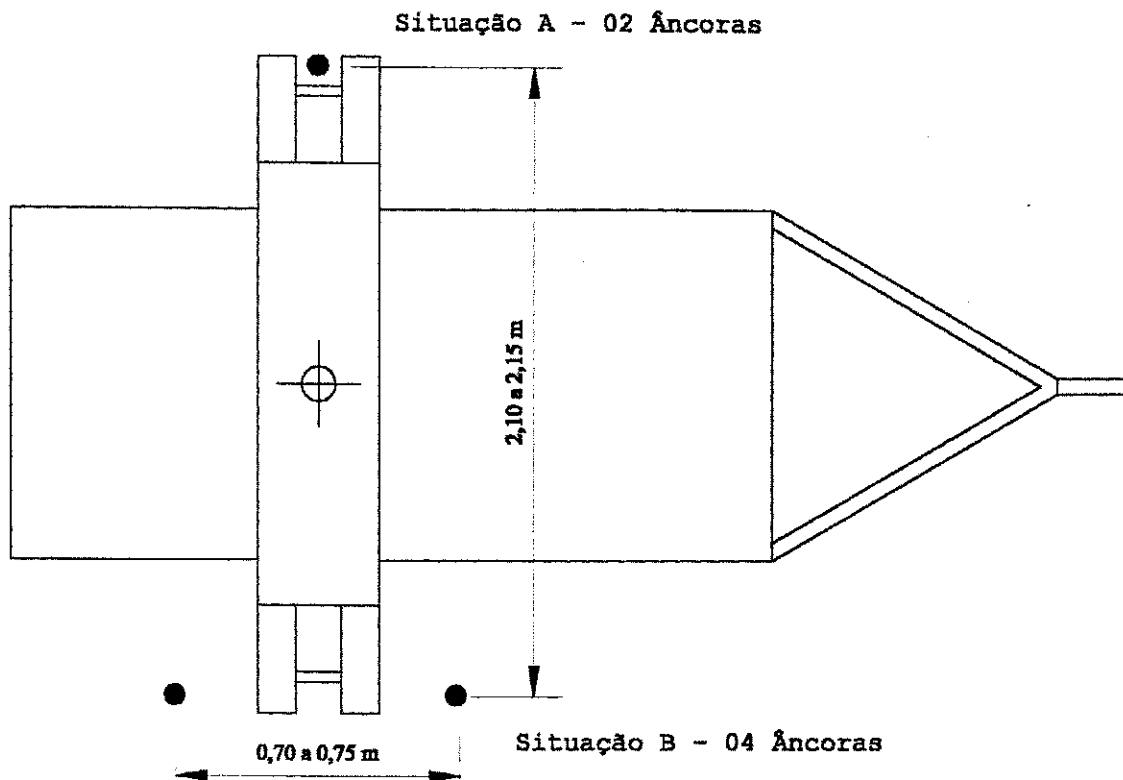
Situações utilizadas para ancoragem da máquina de cravação.
